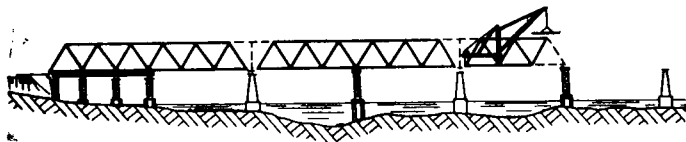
Схема монтажа пролетных строений из сквозных ферм
